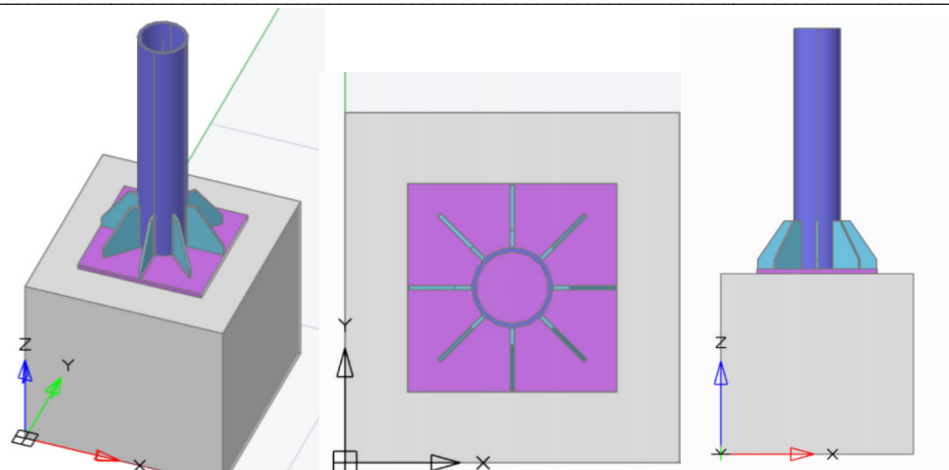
Визуализация узла сопряжения металлической колонны трубным сечением к железобетонному фундаменту «под стакан» в ПК MS
